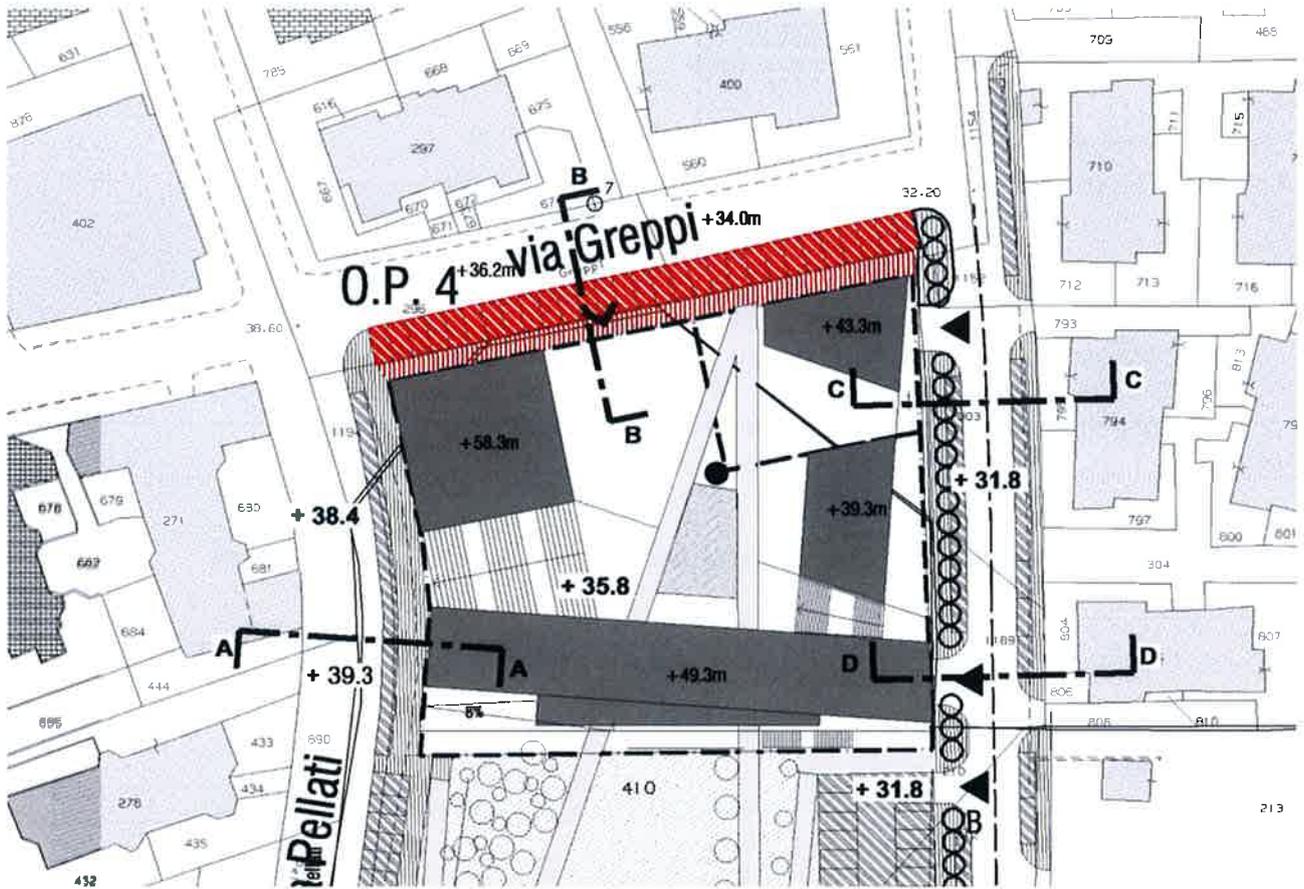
Inquadramento planimetrico dell'opera pubblica n. 4_ scala 1:1000.
